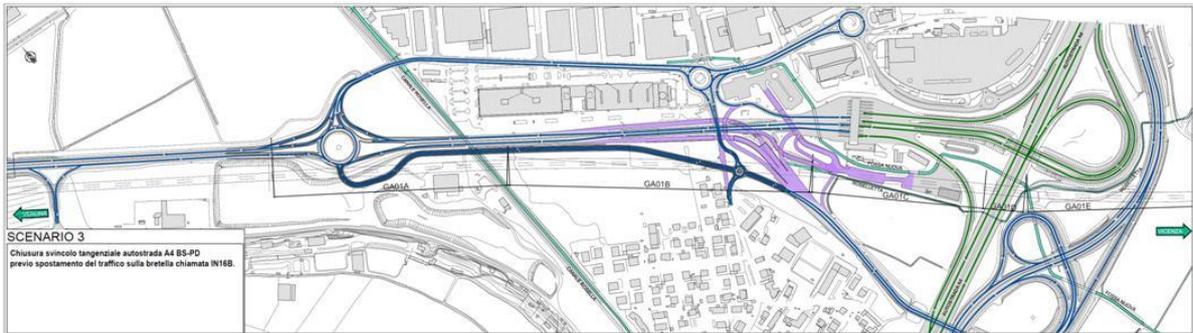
Assetto di rete dello Scenario di cantierizzazione #3
